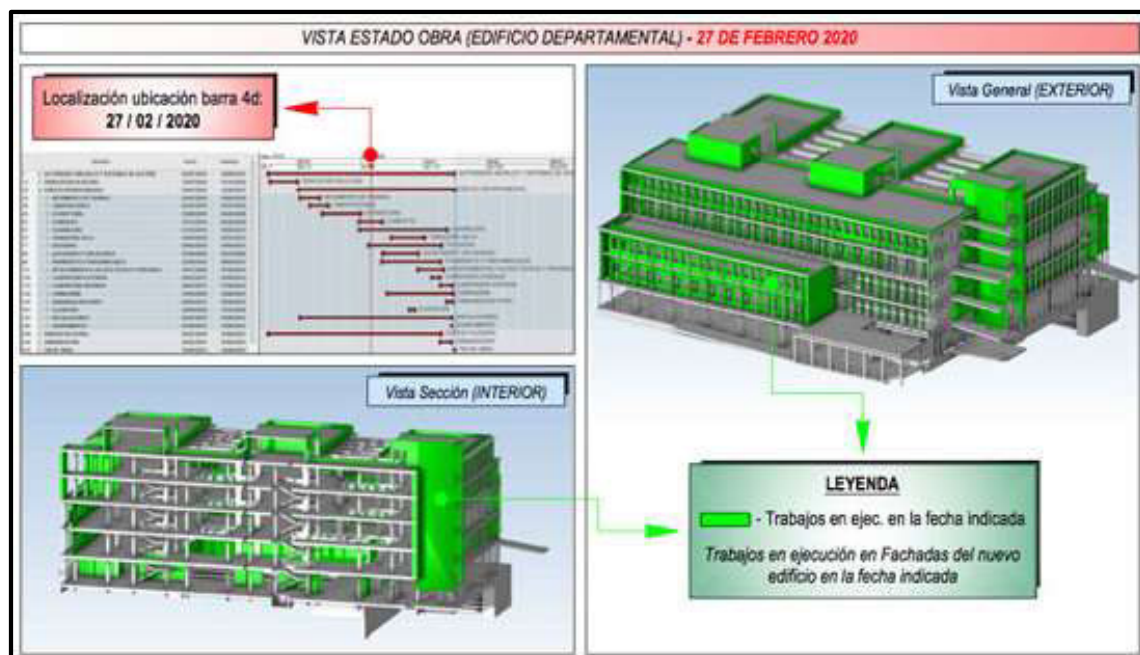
Planificación del proceso constructivo (Fuente: Arravan).
